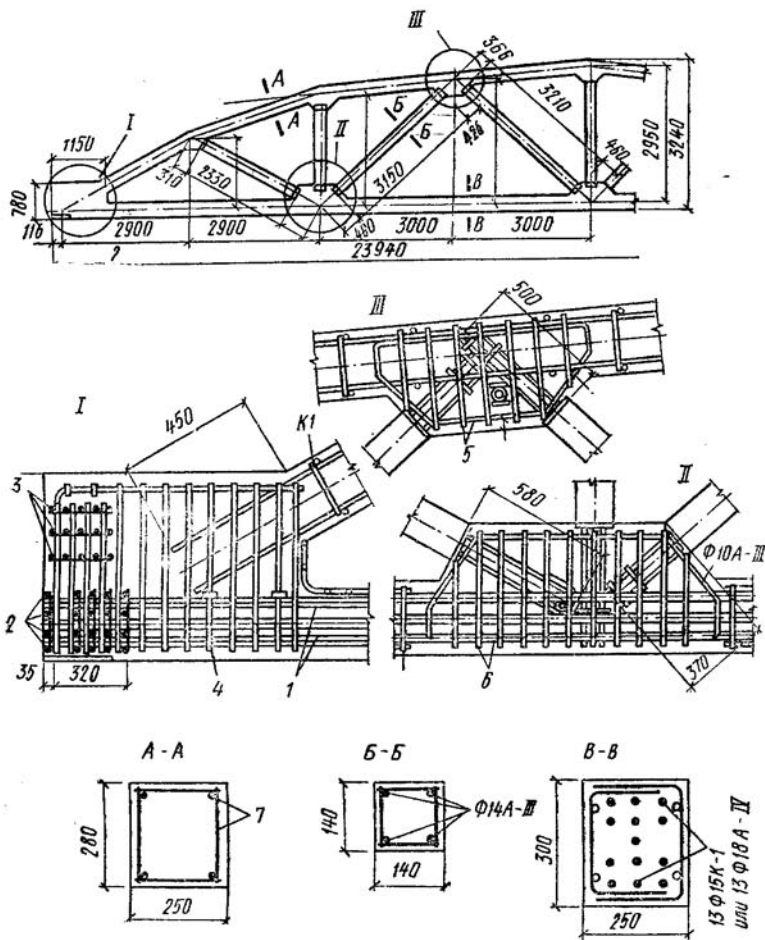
Железобетонная сегментная ферма пролетом 24 м
